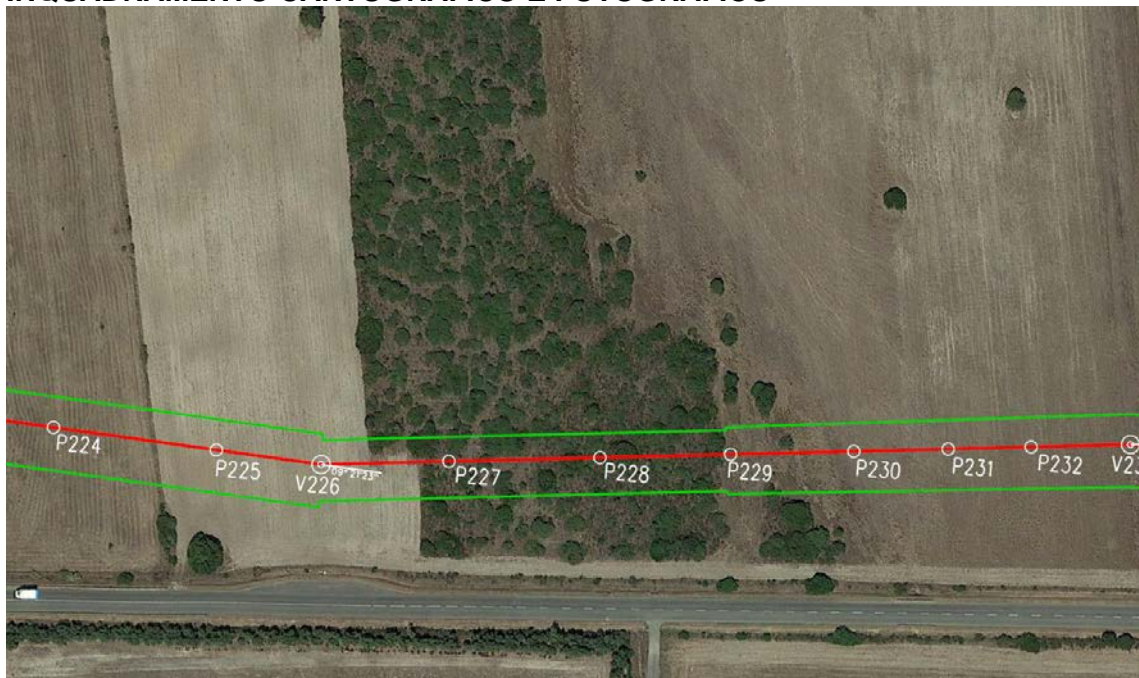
Tratto V226+20mt - P229 - la zona delimitata dalle linee verdi rappresenta la fascia ristretta di lavoro per come previsto dalla GASD C 13.40.10.02
